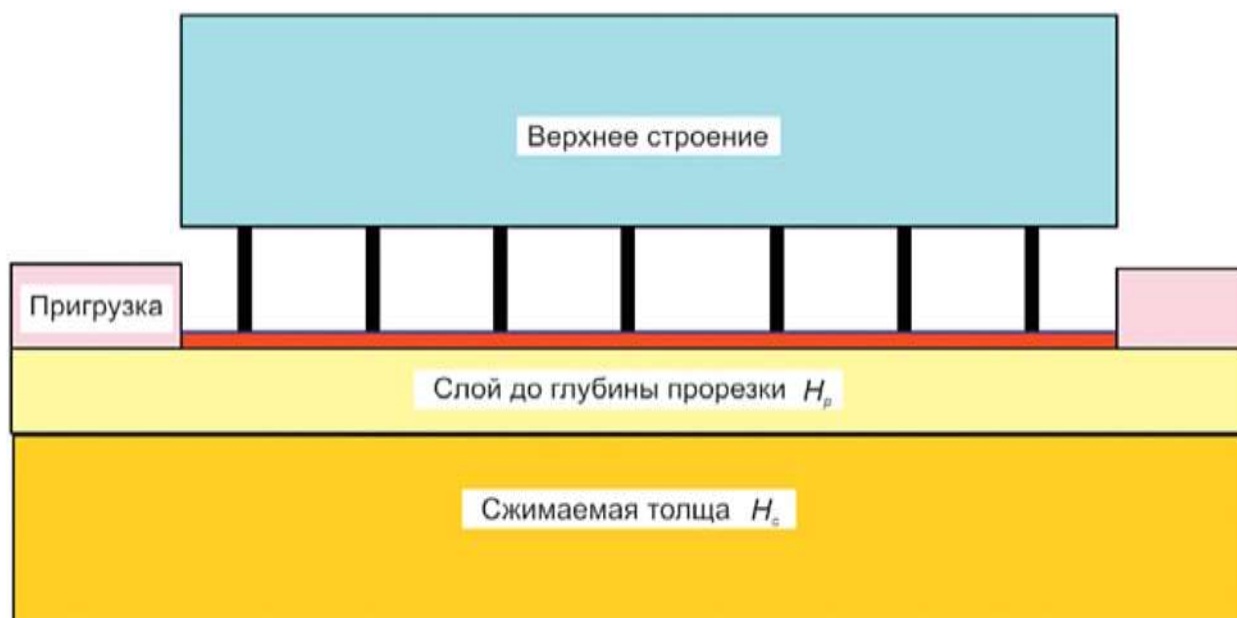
Схема «эталона» СОФС. Красным цветом отмечена фундаментная плита, черные стержни – сжимаемые опоры [5]
